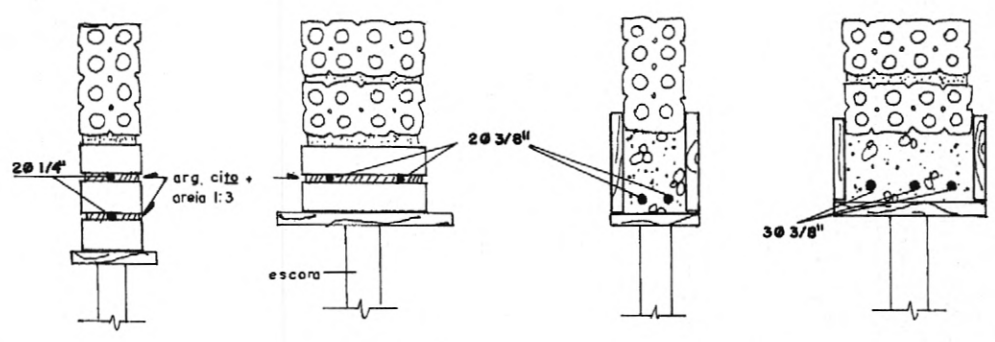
Vergas em alvenaria de tijolo furado para vãos até 1,00m e entre 1,00m e 2,00m
